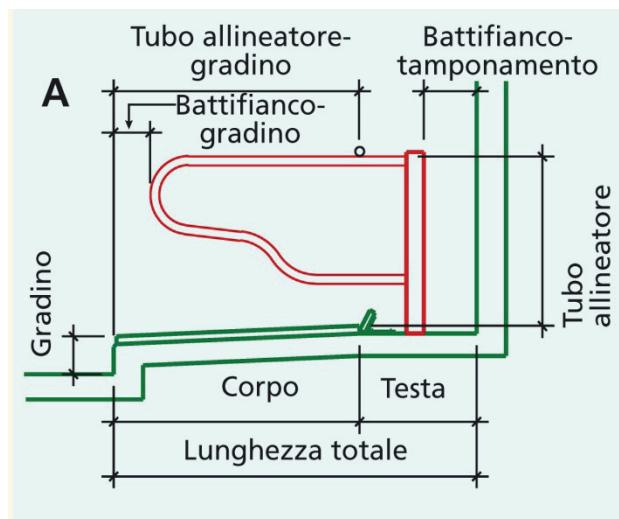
Schema di una cuccetta singola con pavimento pieno in pendenza, materassino sintetico e tamponamento anteriore: elementi di base.
